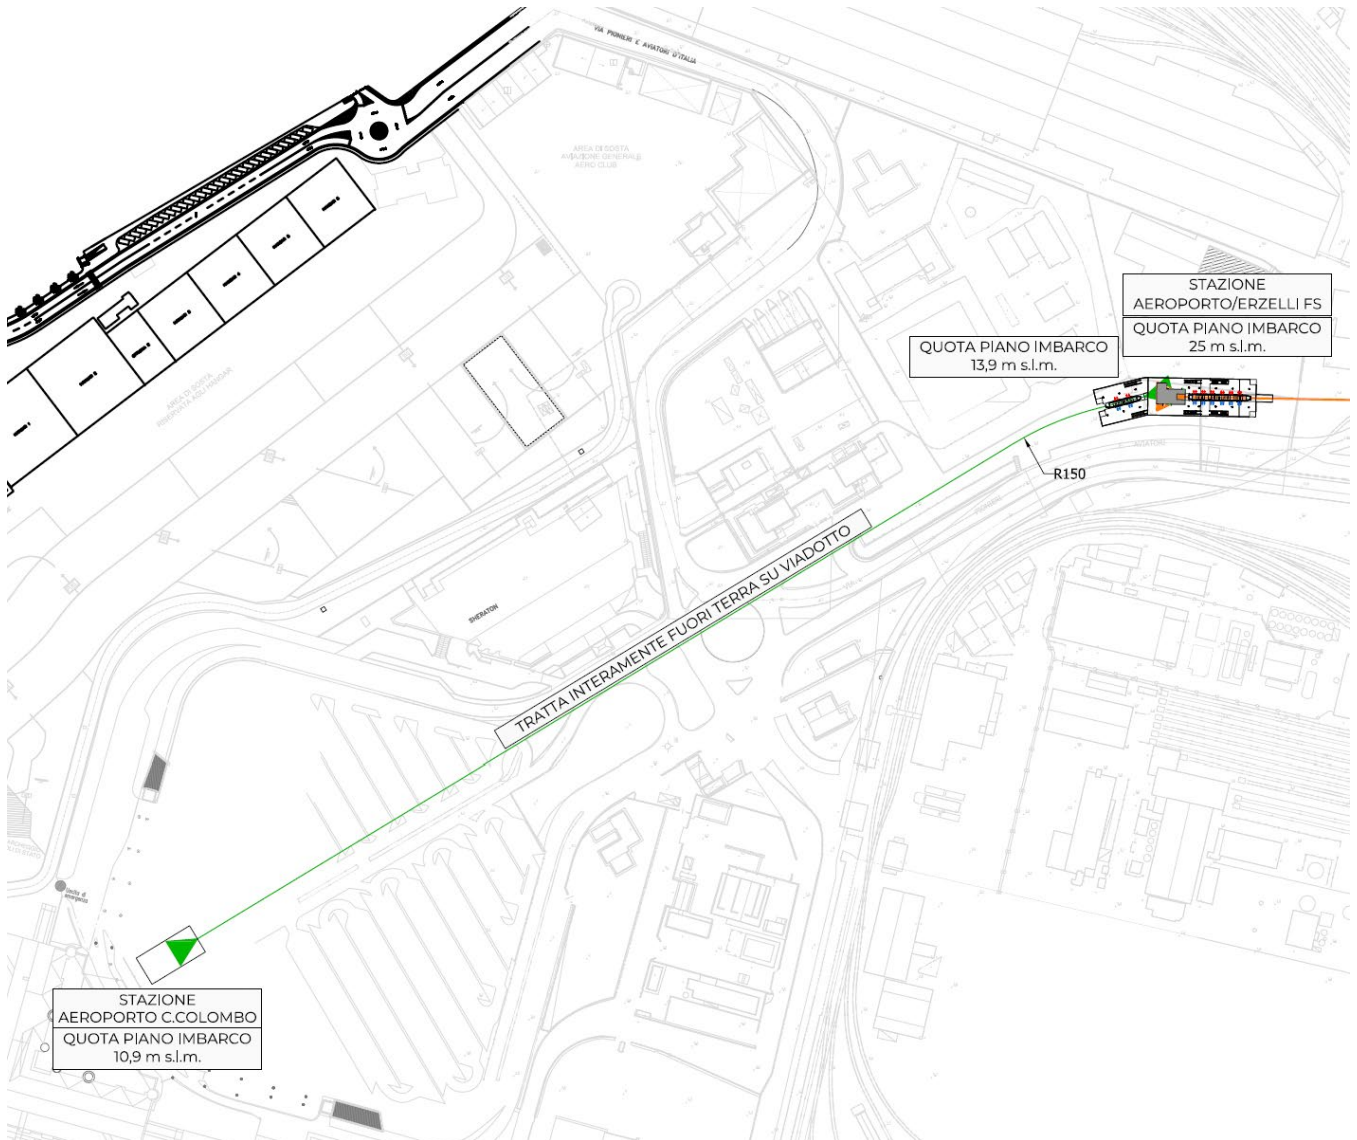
tracciato planimetrico funicolare “Aeroporto - Erzelli FS”
